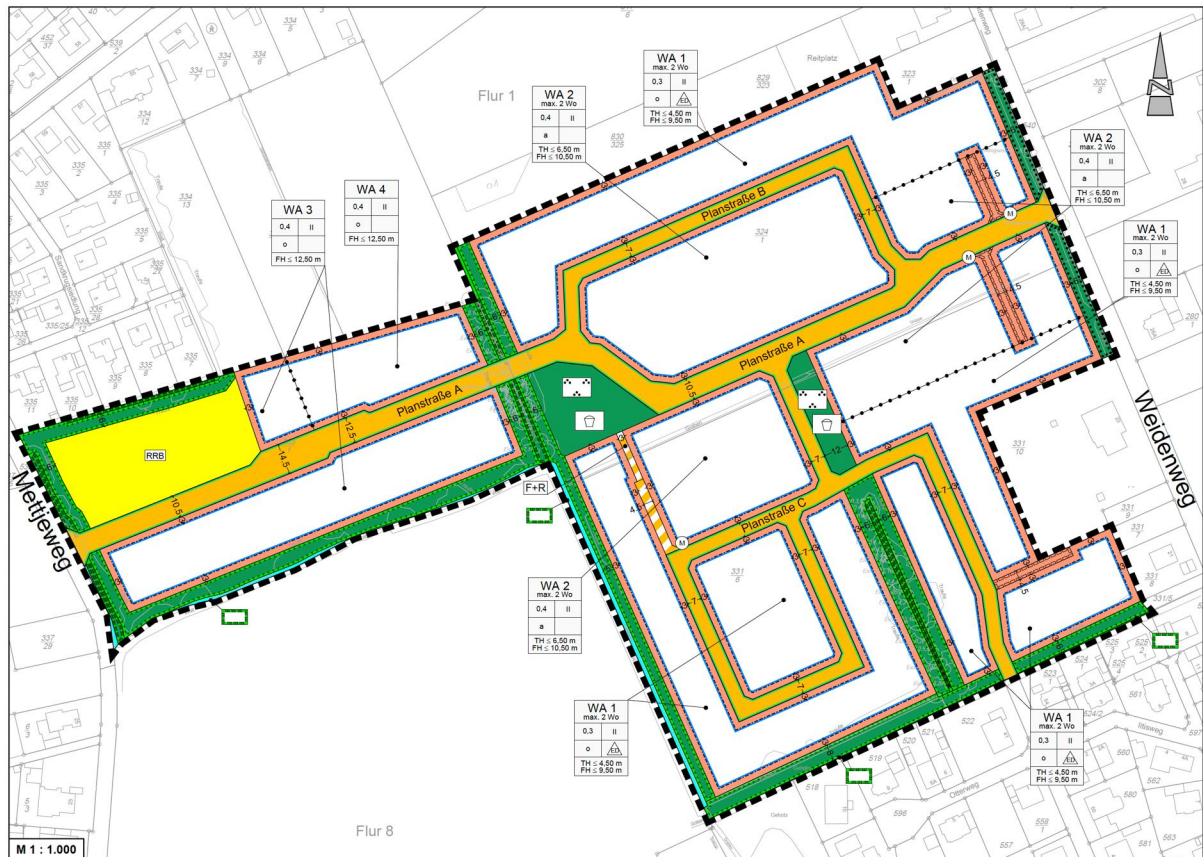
Planzeichnung Bebauungsplan 235, Stand 10-2024
